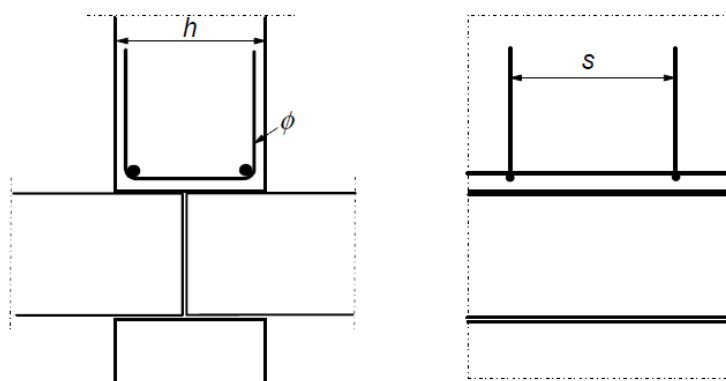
Detalhe da armadura em painéis para resistir às tensões de tração laterais. [Fonte: Eurocode 2]
